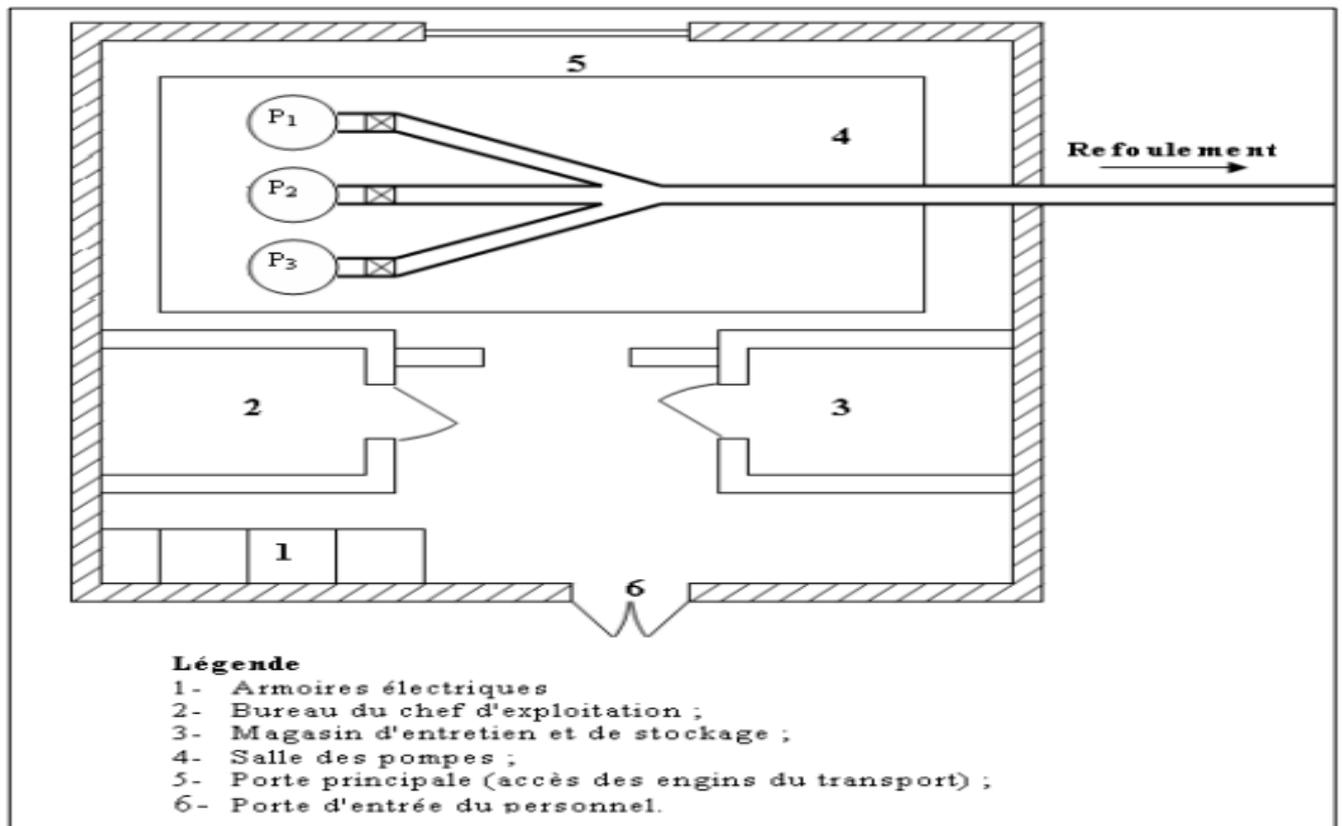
schéma du bâtiment de la station de relevage. [6]
